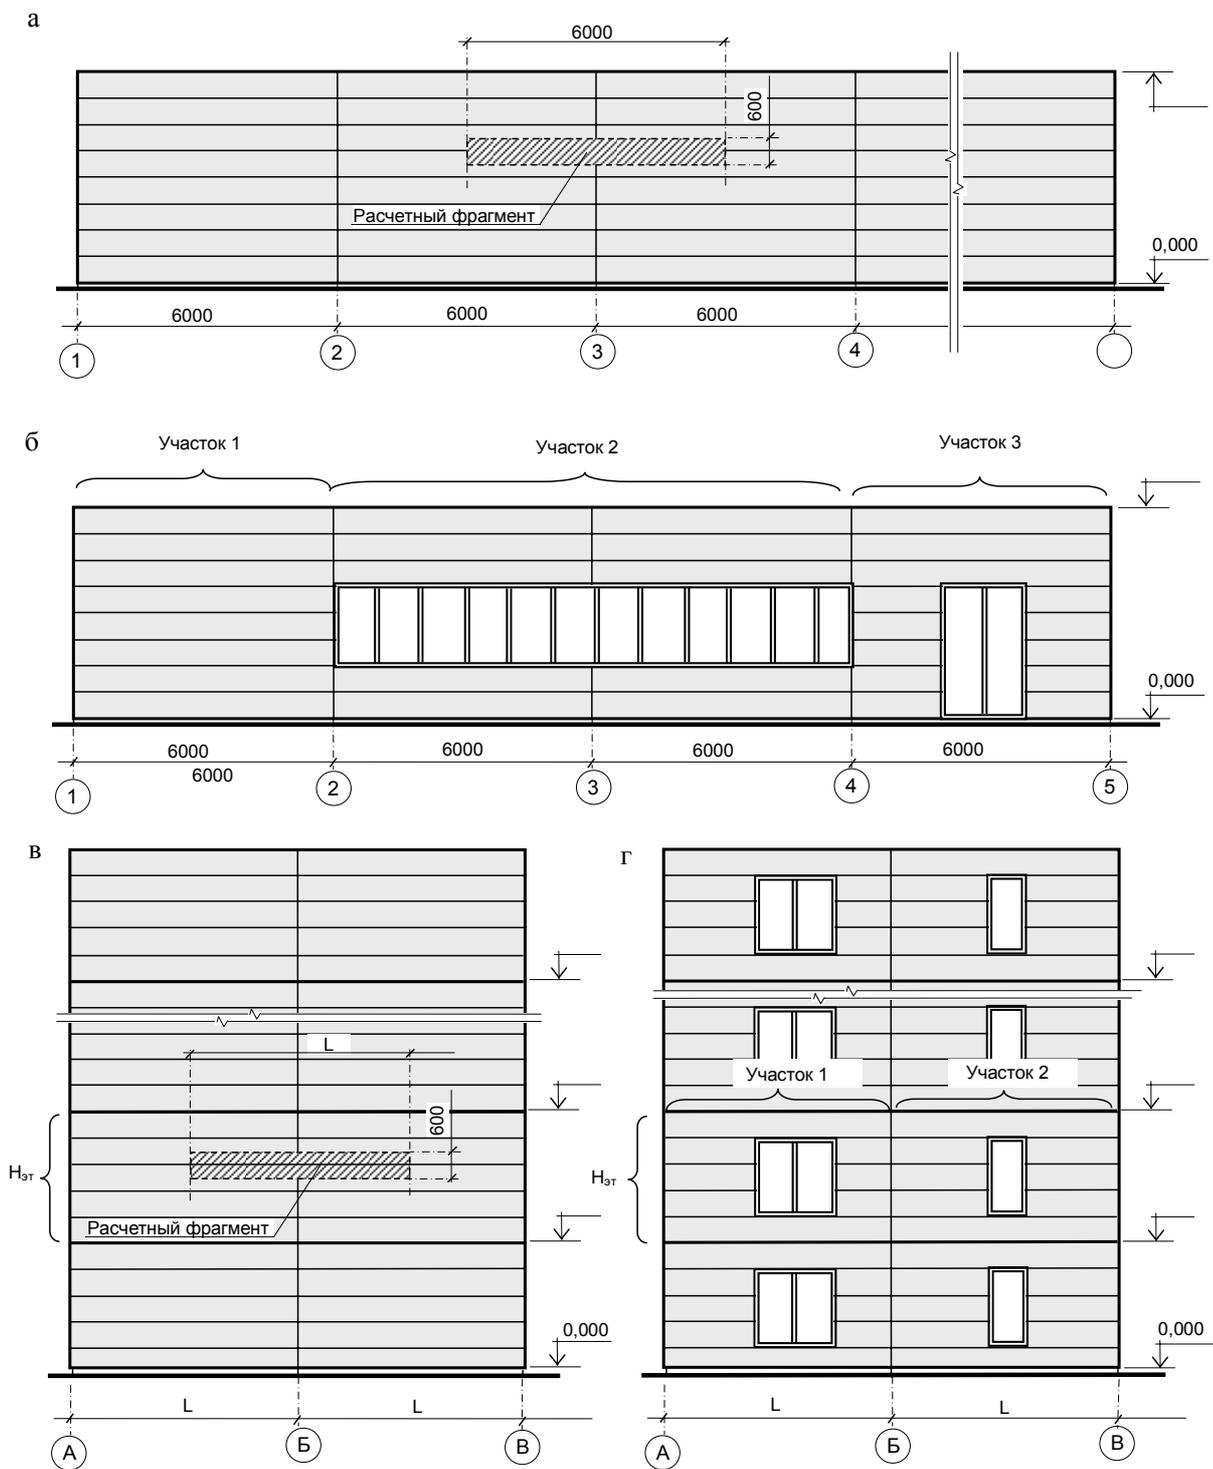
Примеры разбиения фасадов на расчетные участки для определения приведенного сопротивления теплопередаче фасада (а, б) или промежуточного этажа (в,г)
